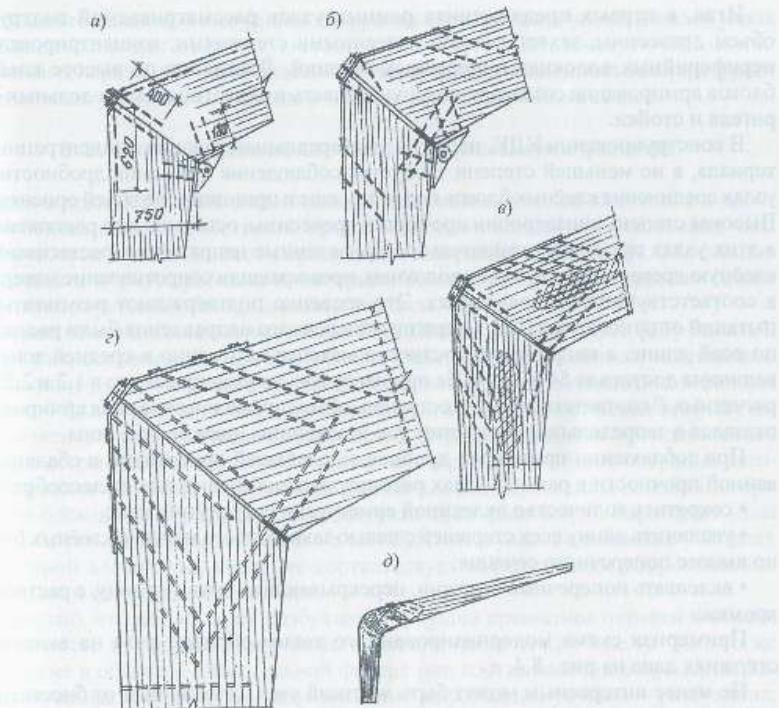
Сборные жесткие узлы на вклеенных стержнях: а, б, в – опытные варианты конструкций с включением в работу не всех слоев досок; 2 – включение всей высоты пакета при удалении вклеенных стержней; д – вариант жесткого узла вне зоны действия максимального M
